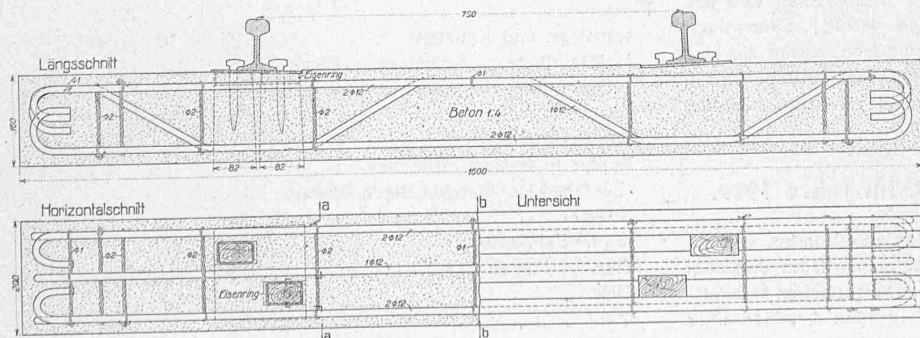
und 2. Schnitte und Draufsicht der Eisenbeton-Schwelle. — Masstab 1:12.
